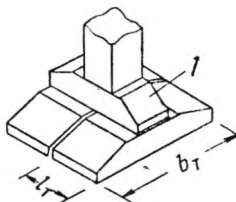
Сборный фундамент из типовых блоков-подушек под столб
